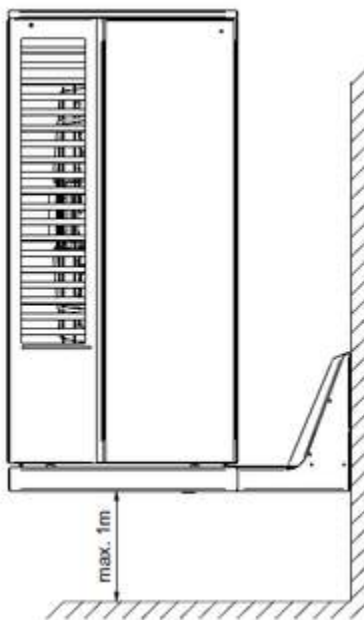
Installation du poste extérieur M Flex et du système M avec support mural
